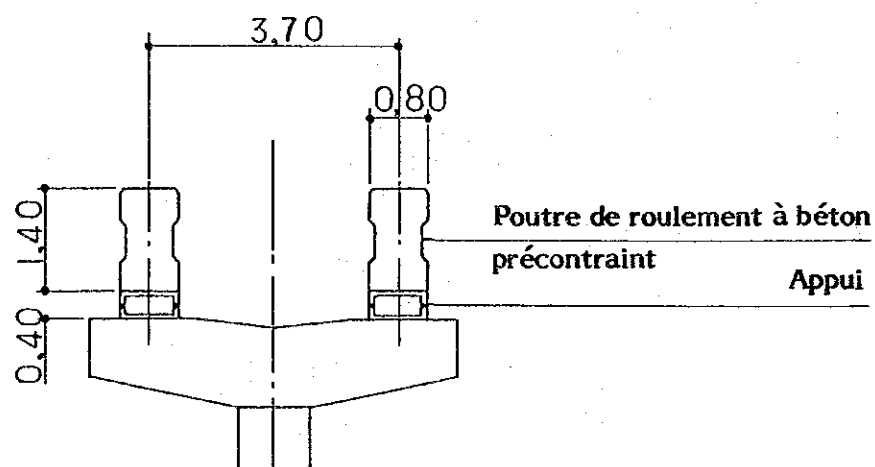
Voie de roulement (monorail sur poutre)
